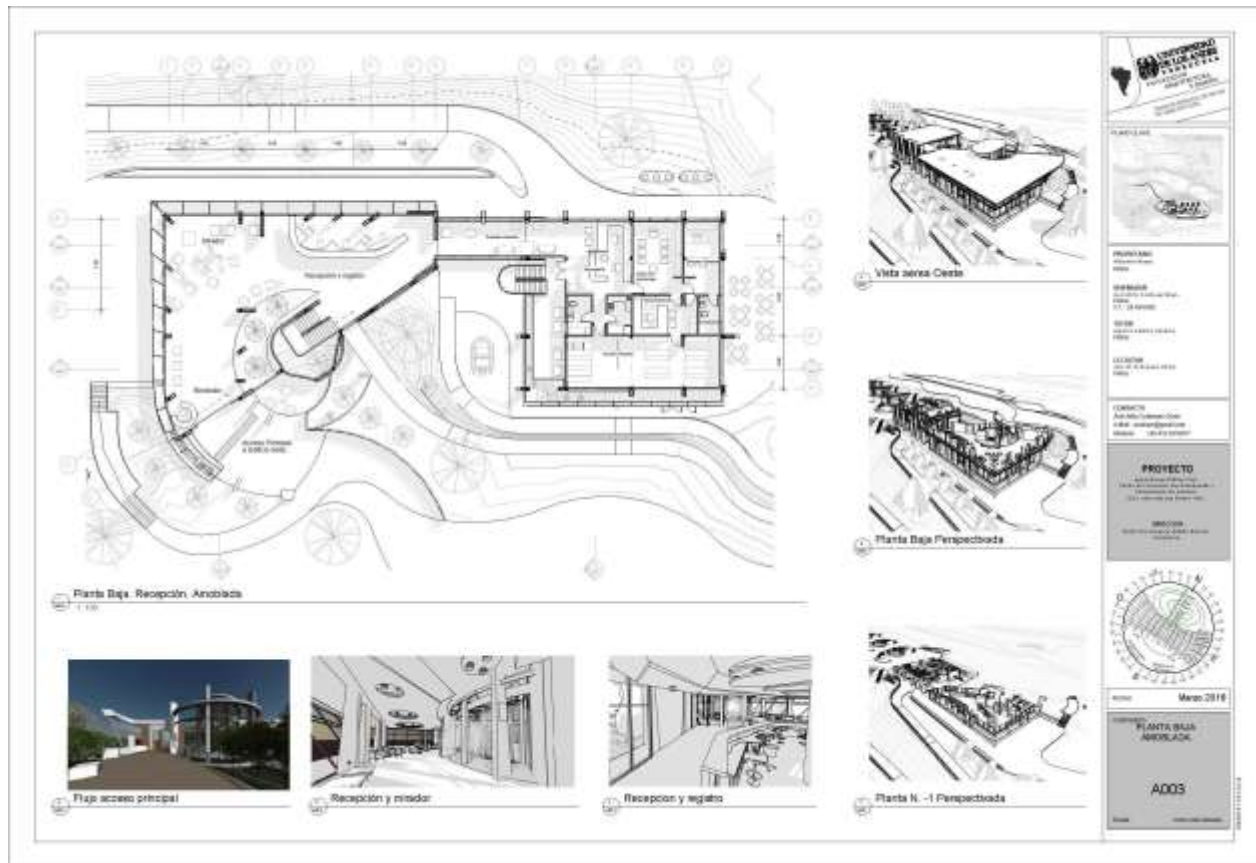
Planta Baja amoblada y vistas, Edificio Sede Central.
